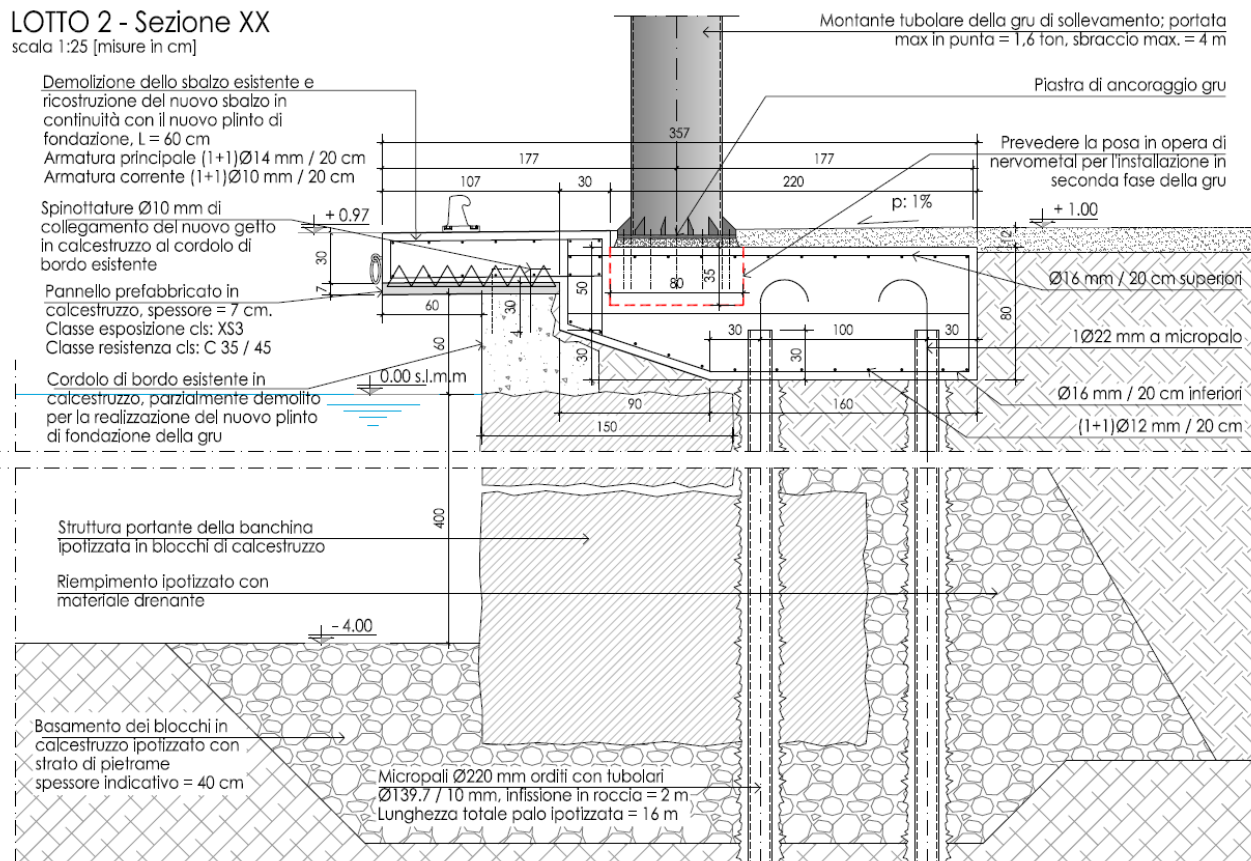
sezione trasversale stralcia del sistema di fondazione della nuova gru
